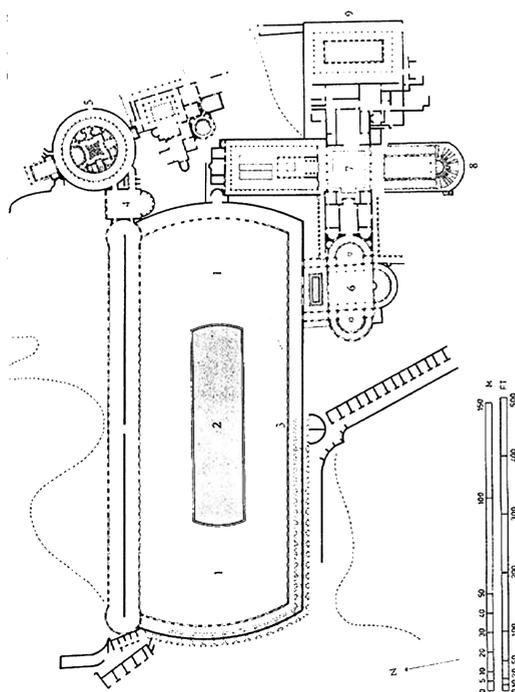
Coarelli, 1977, planimetria dell'area del Pecile
